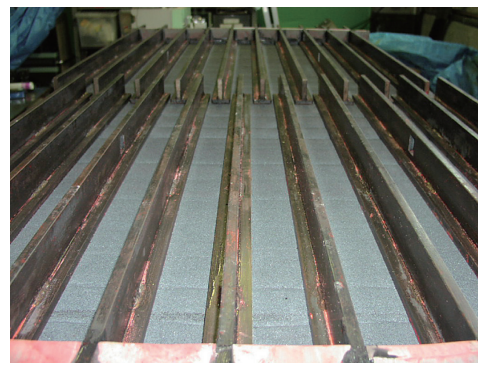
試験終了後防塵層上面状況 (遊間 1 964 mm)
